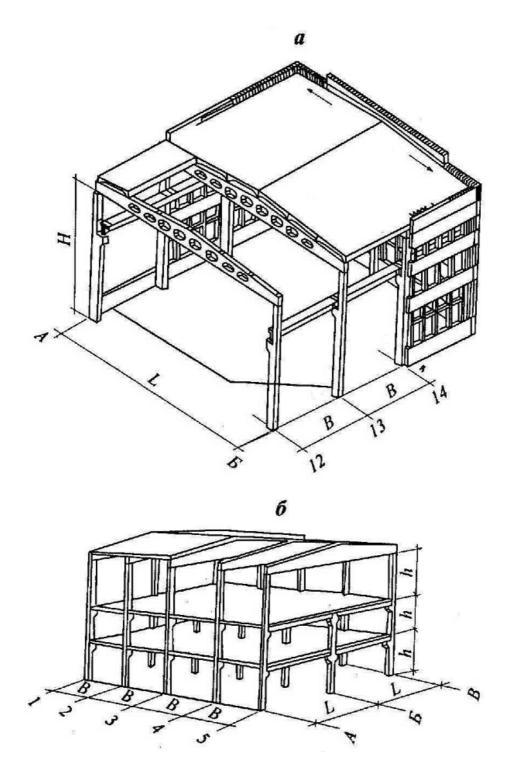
Основные параметры объёмно-планировочного решения промышленных зданий (а – одноэтажных; б – многоэтажных): L – пролёт; B – шаг; H – высота одноэтажного здания; h – высота этажа
